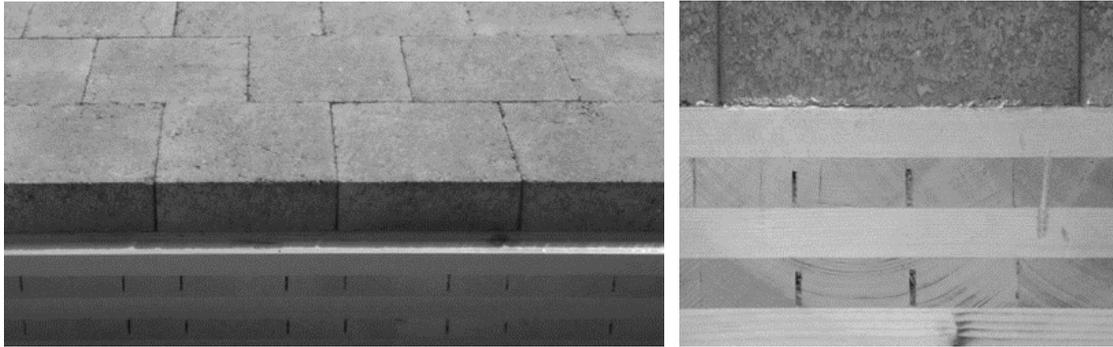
Aufgeklebte Betonplatten auf Brettsperrholz
